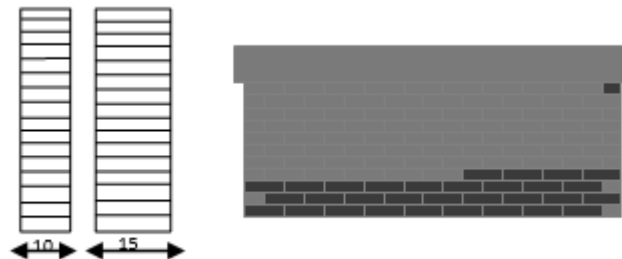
Murs extérieurs (doubles parois en briques creuses)
